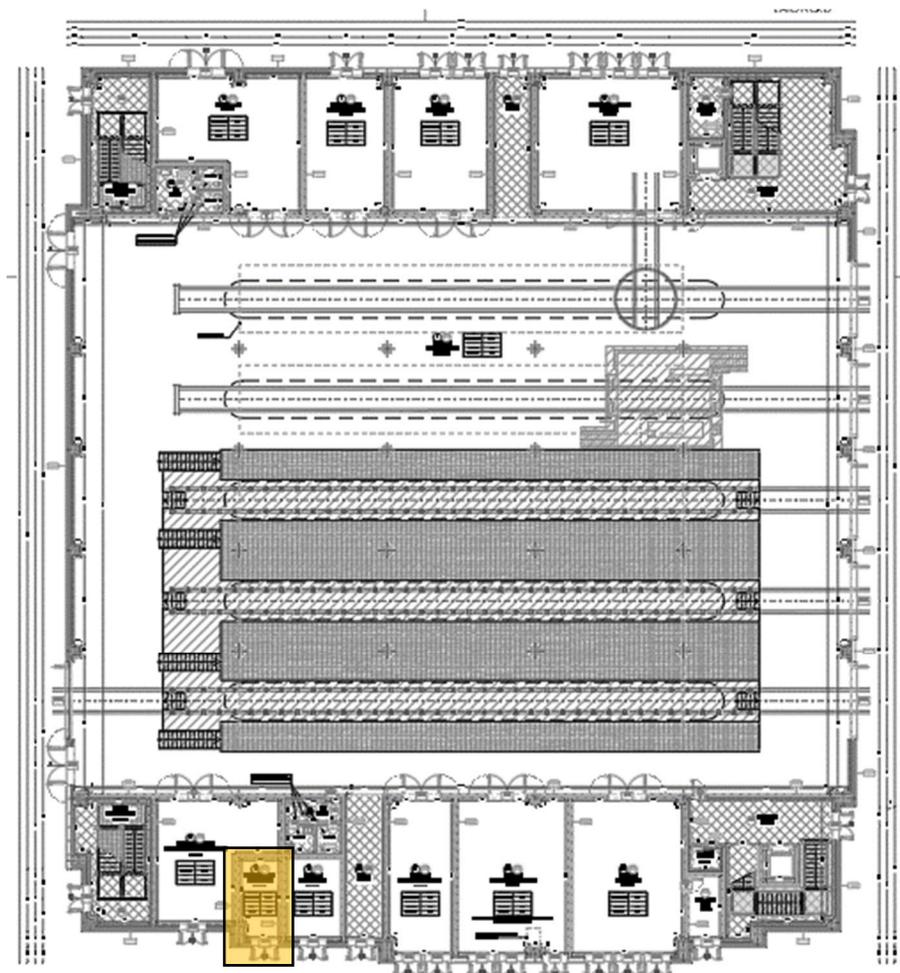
Vista planimetrica officina rotabili - impianto aria compressa in evidenza
